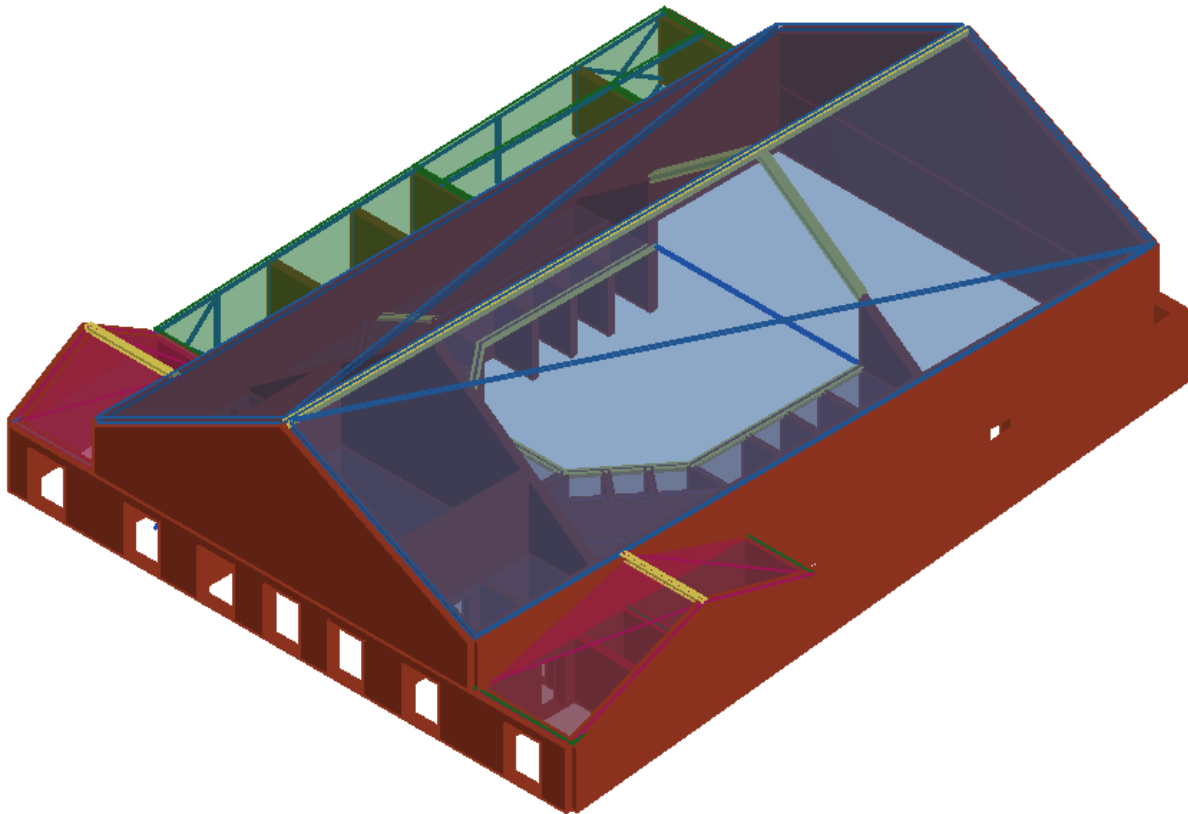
Vista assonometrica delle piano del III ordine dei palchi e del tetto nello stato di Progetto
